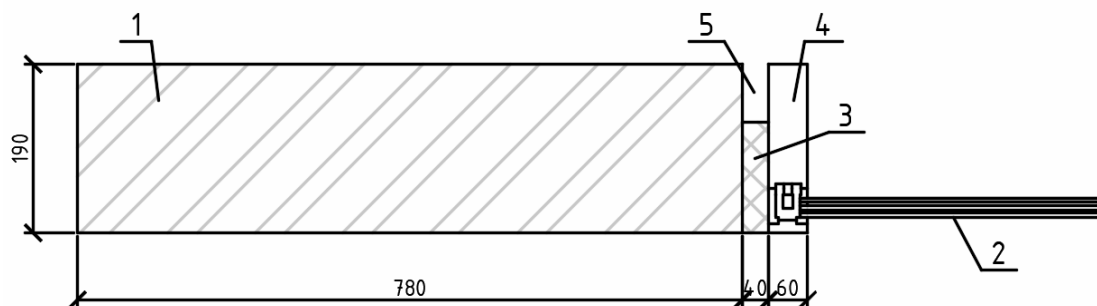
Схема сечения узла примыкания оконного блока к стеновому проему с дефектом без утеплителя
